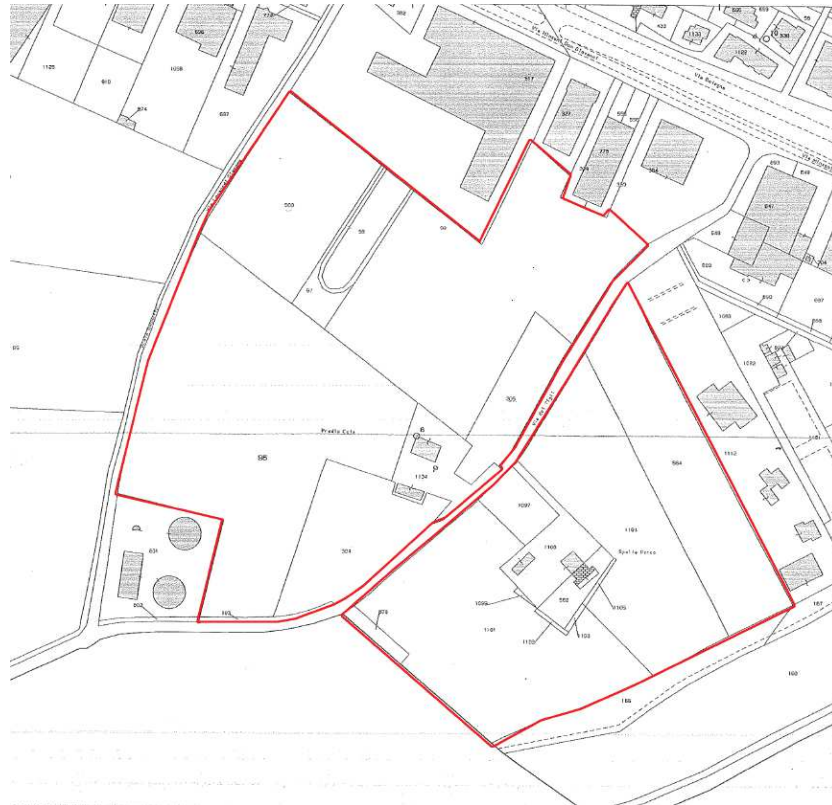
Planimetria zona oggetto di intervento (in rosso)
